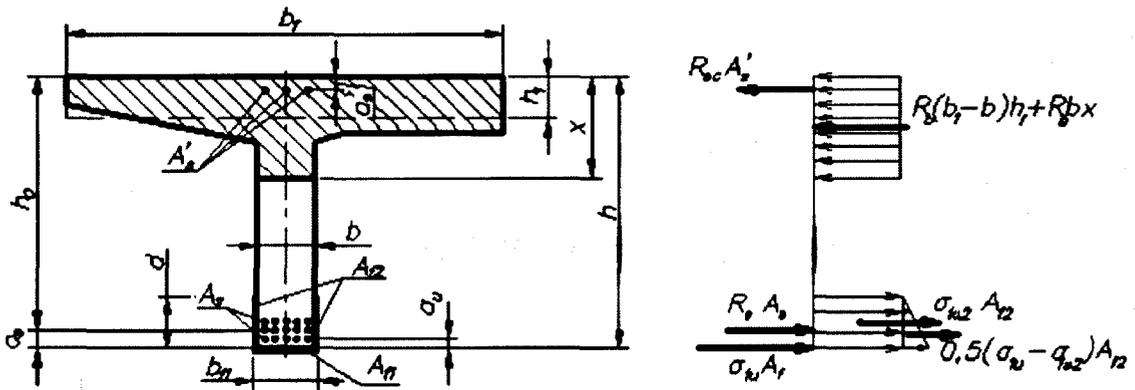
Расчетное сечение тавровой балки при расположении границы сжатой зоны в ребре
